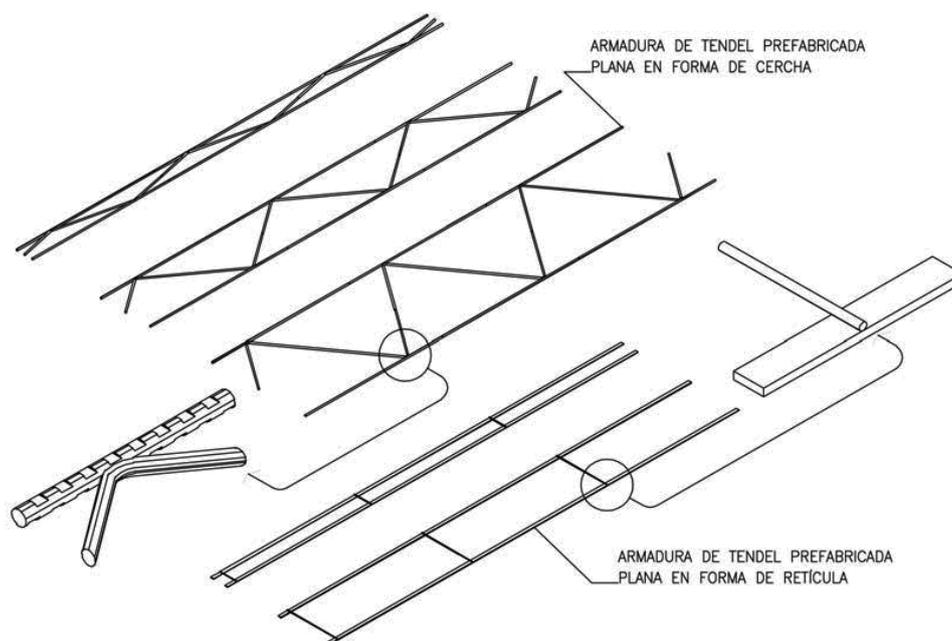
Tipologías de armaduras de tendel prefabricadas planas: en cercha y en retícula de distintos anchos y prestaciones.
